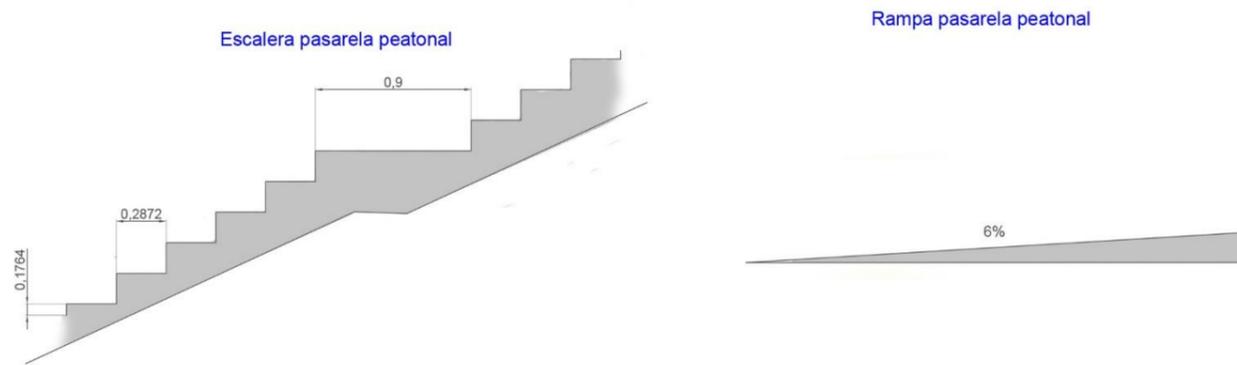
Detalle de la rampa y escaleras. Fuente: Elaboración Propia.
